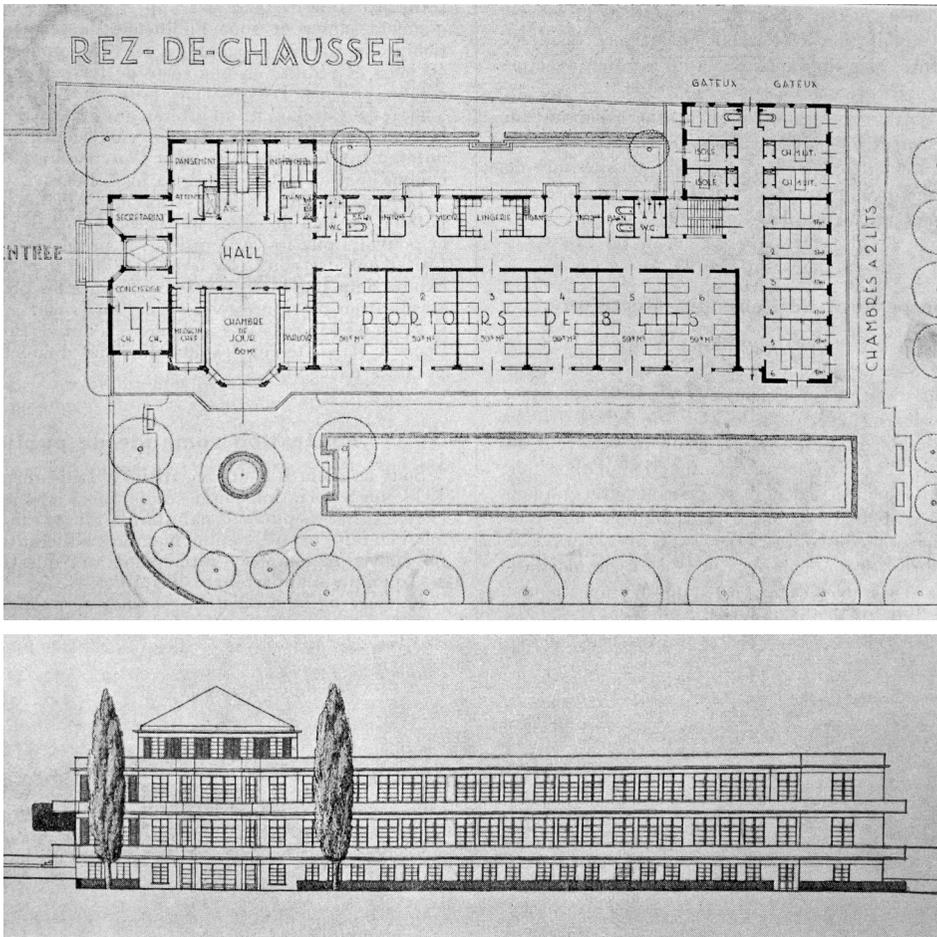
Lausanne, Hospice Sandoz, projet de concours de Charles Thévenaz, plan du rez-de-chaussée et élévation (tiré de : *BTSR*, 1928).
